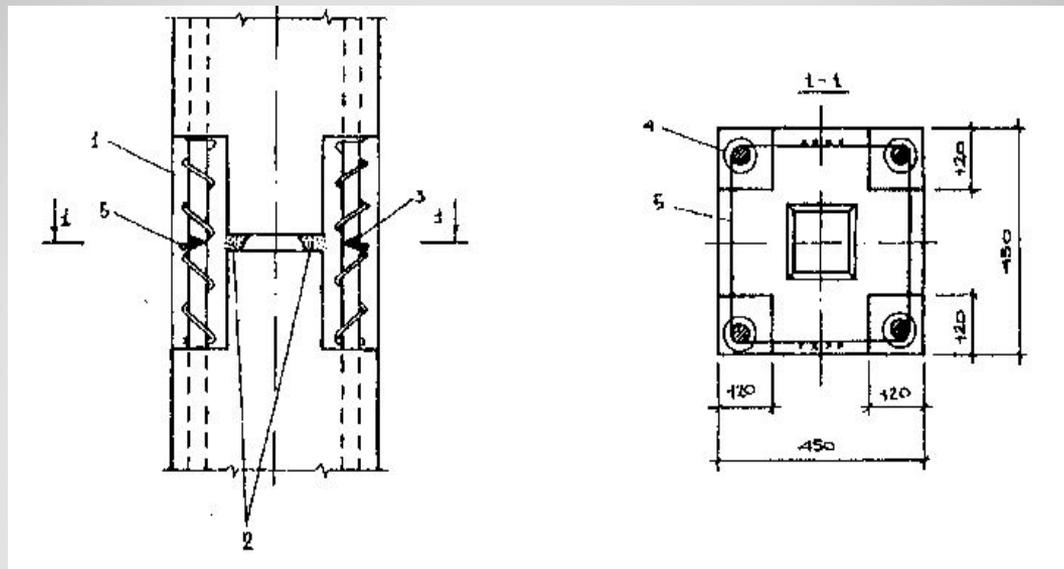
Стык колонн с ванной сваркой арматуры
